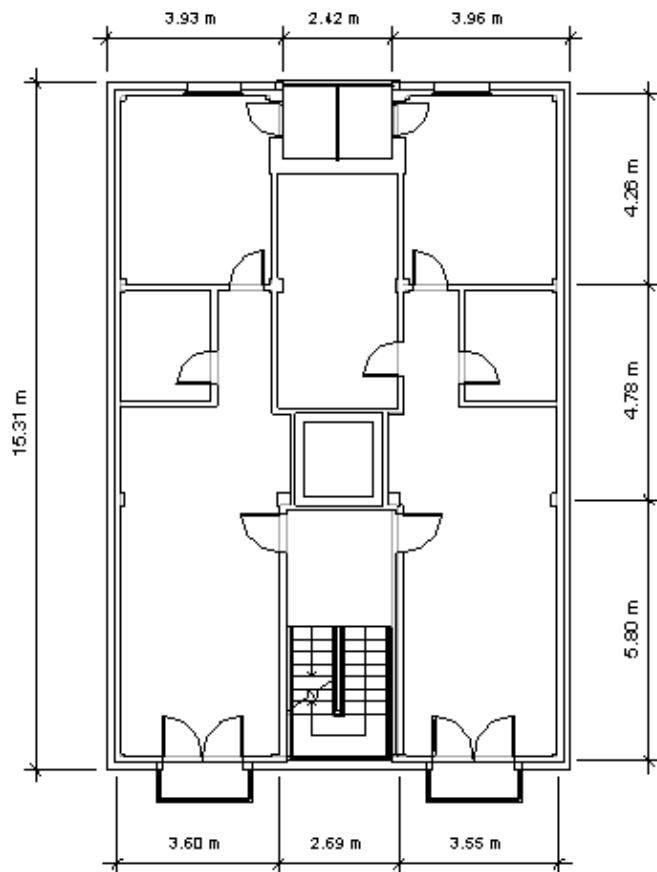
Plano de planta tipo del edificio convencional (Fuente: elaboración propia)
